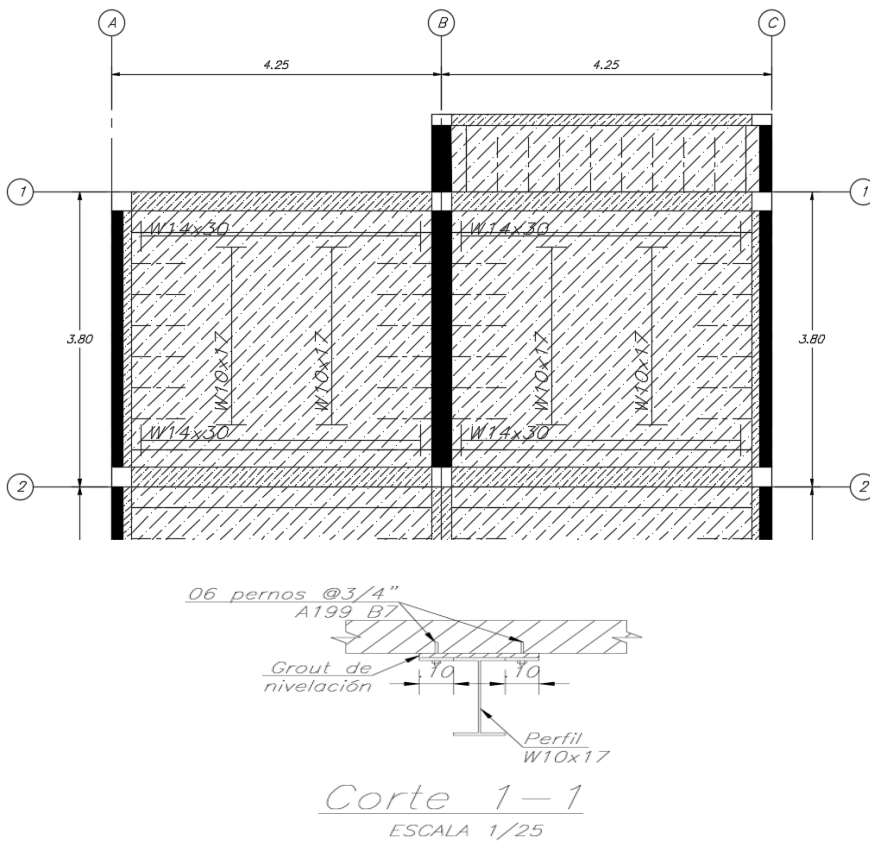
Esquemas de reforzamiento con Vigas metálicas, por debajo de la losa
